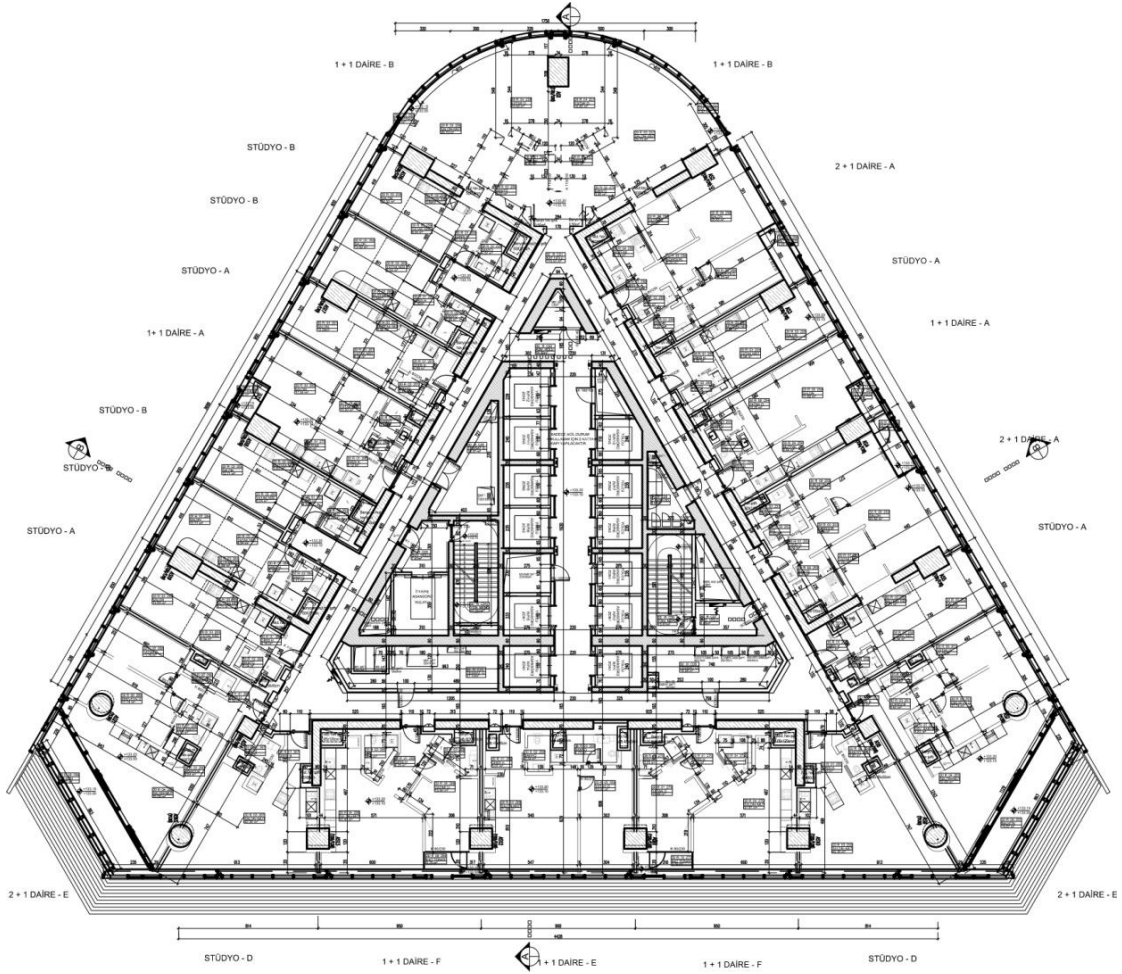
Skyland Konut Bloğu Kat Planı (Eroğlu Gayrimenkul Geliştirme)
